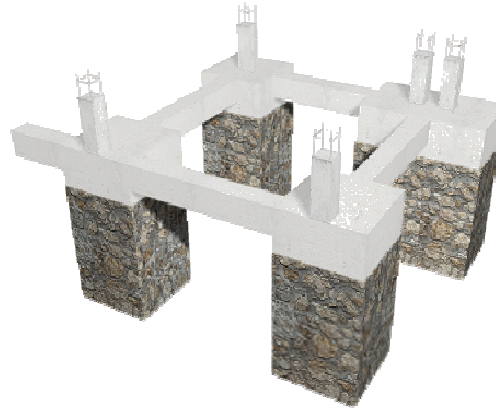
Modelo de cimentación planteado mediante pozos de cimentación.
